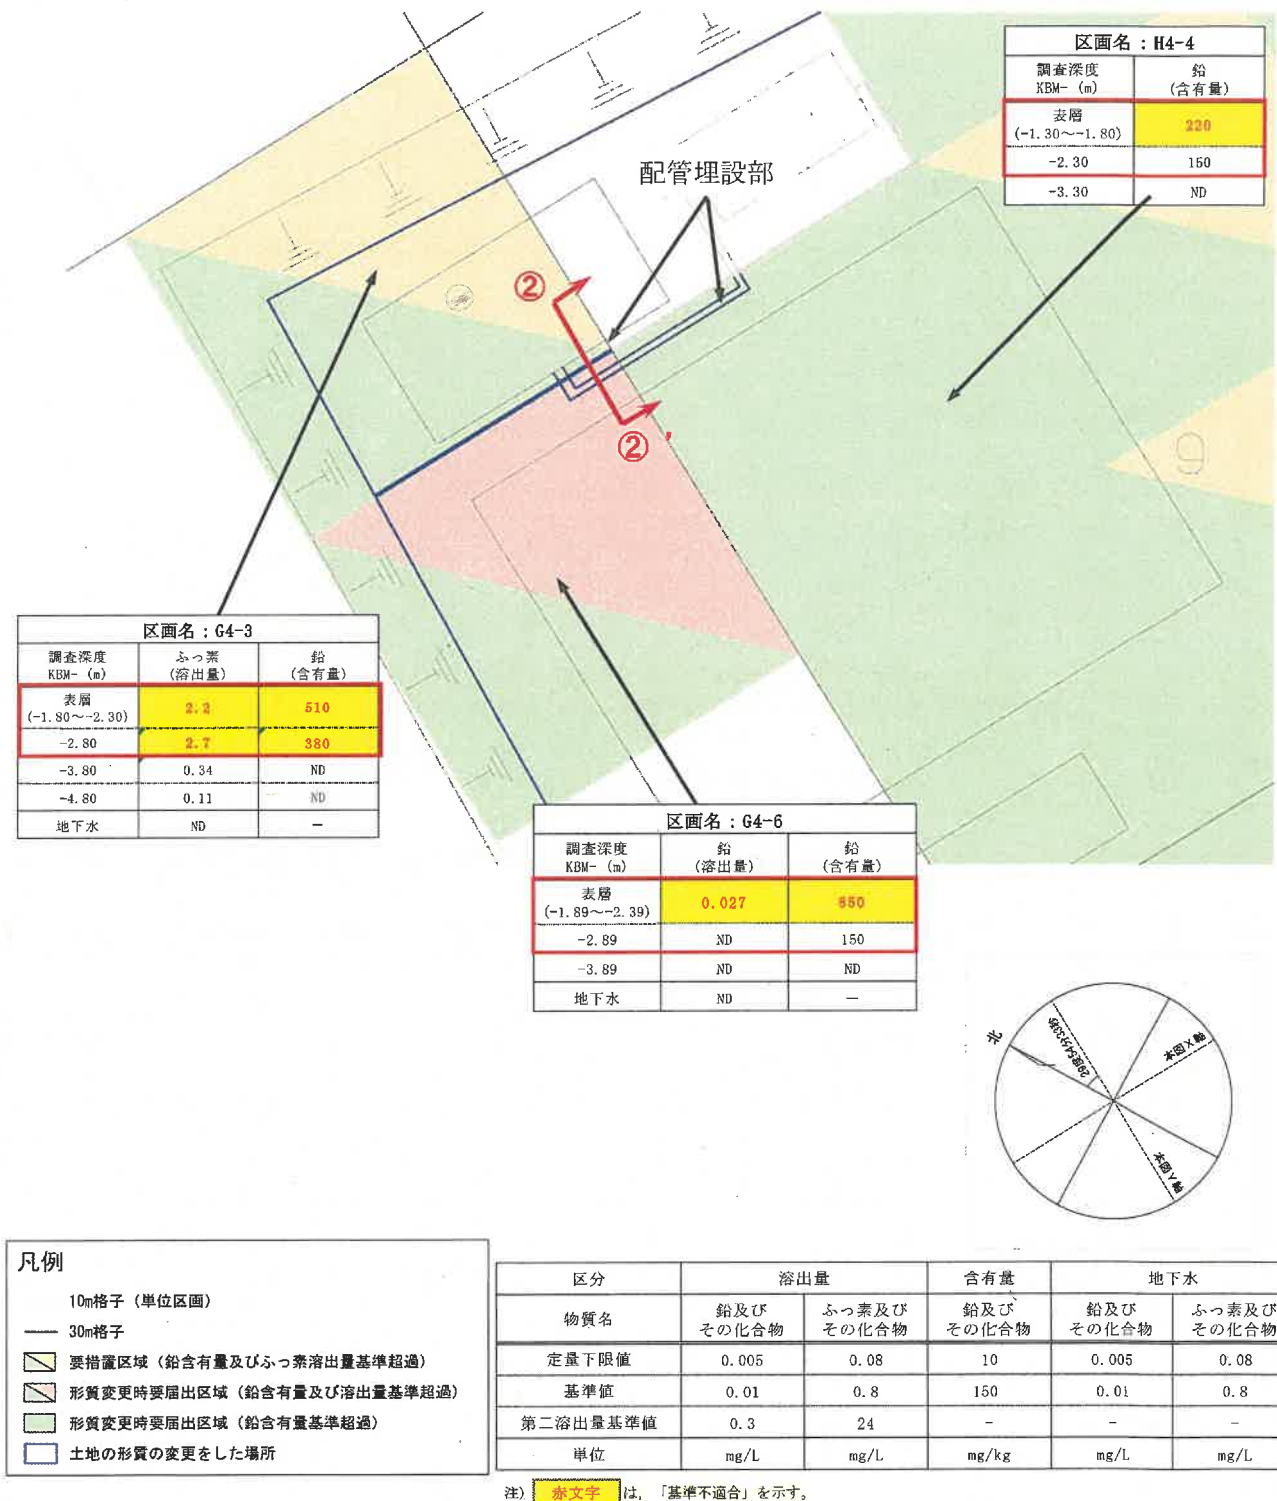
土地の形質の変更の施行方法を明らかにした平面図 (配管理設工事)
